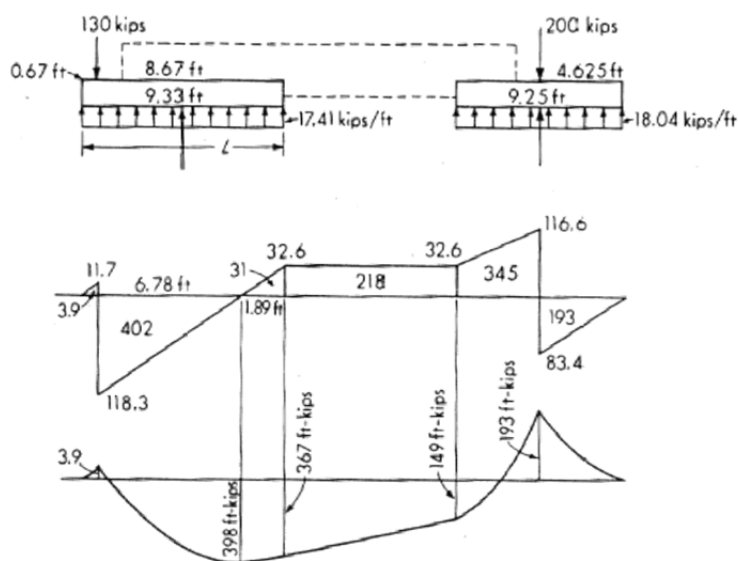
Esfuerzos de diseño. Zapatas aisladas unidas con viga. Bowles [13].
